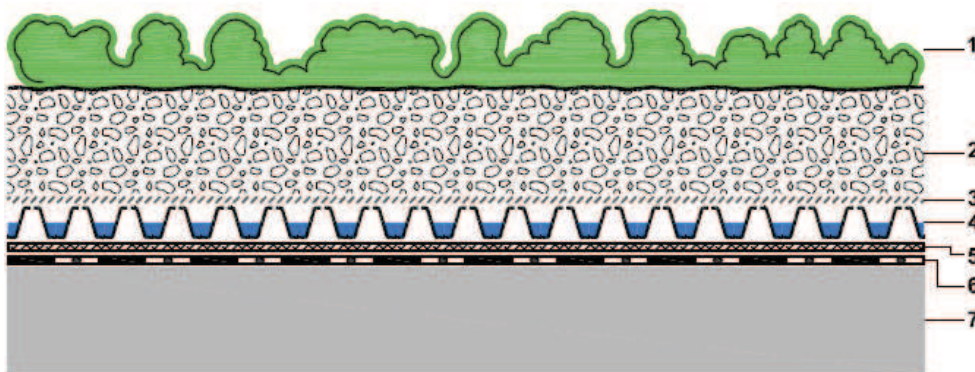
Pormenor construtivo da cobertura ajardinada, NEOTURF
